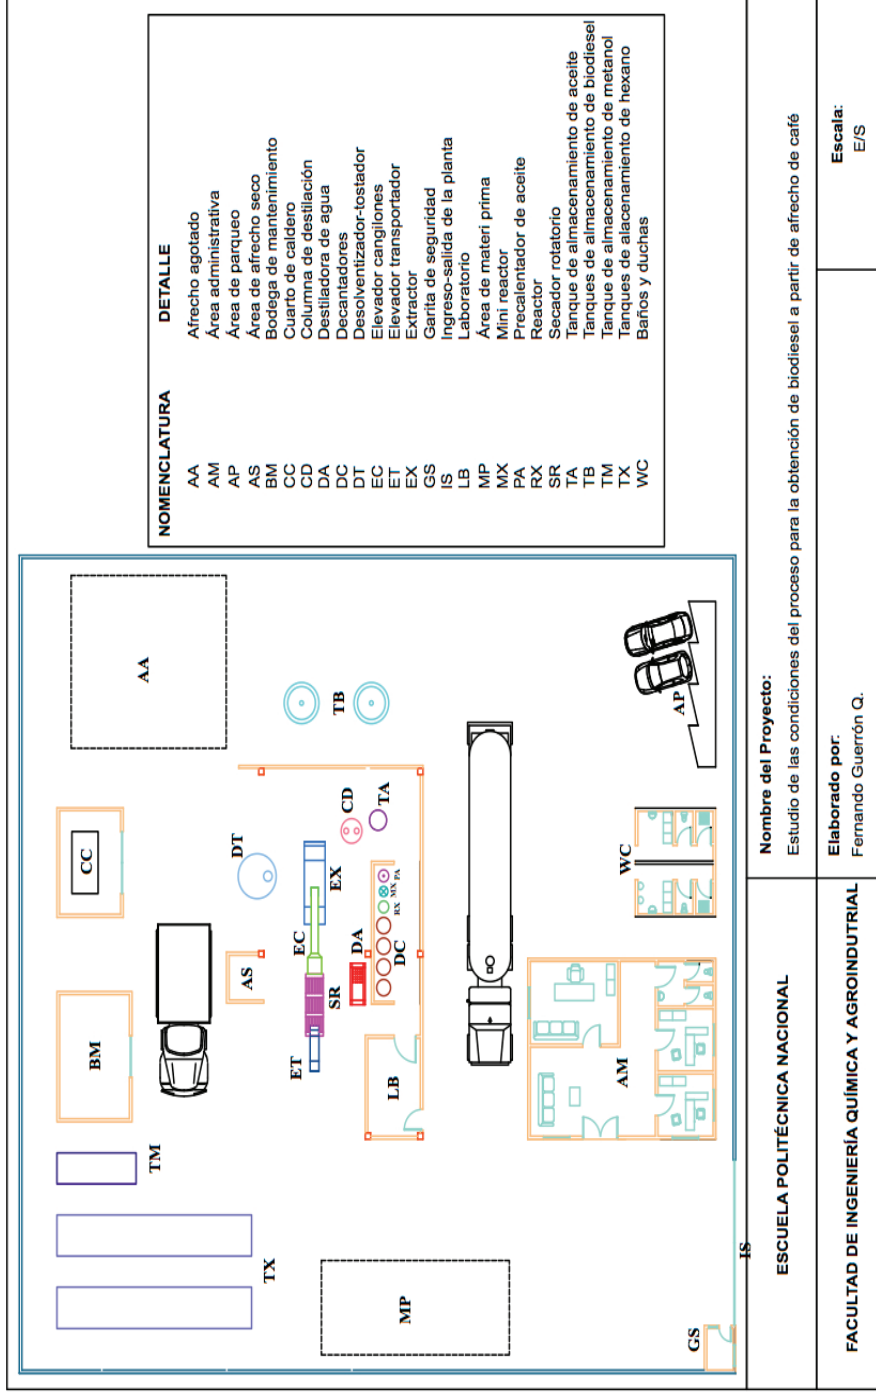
Plano vista superior de los equipos y áreas de la planta
